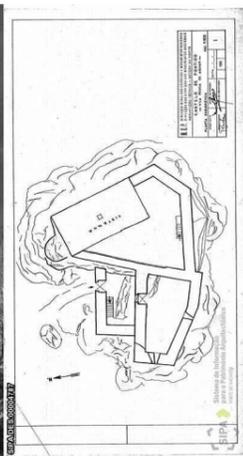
Planta do Castelo Roqueiro de Pena de Aguiar
